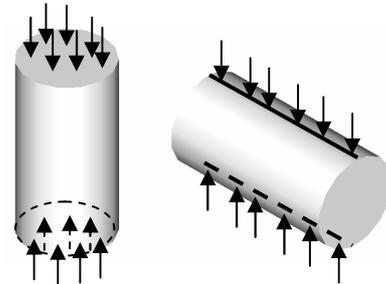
Essais de compression et de traction sur éprouvettes 16x32
